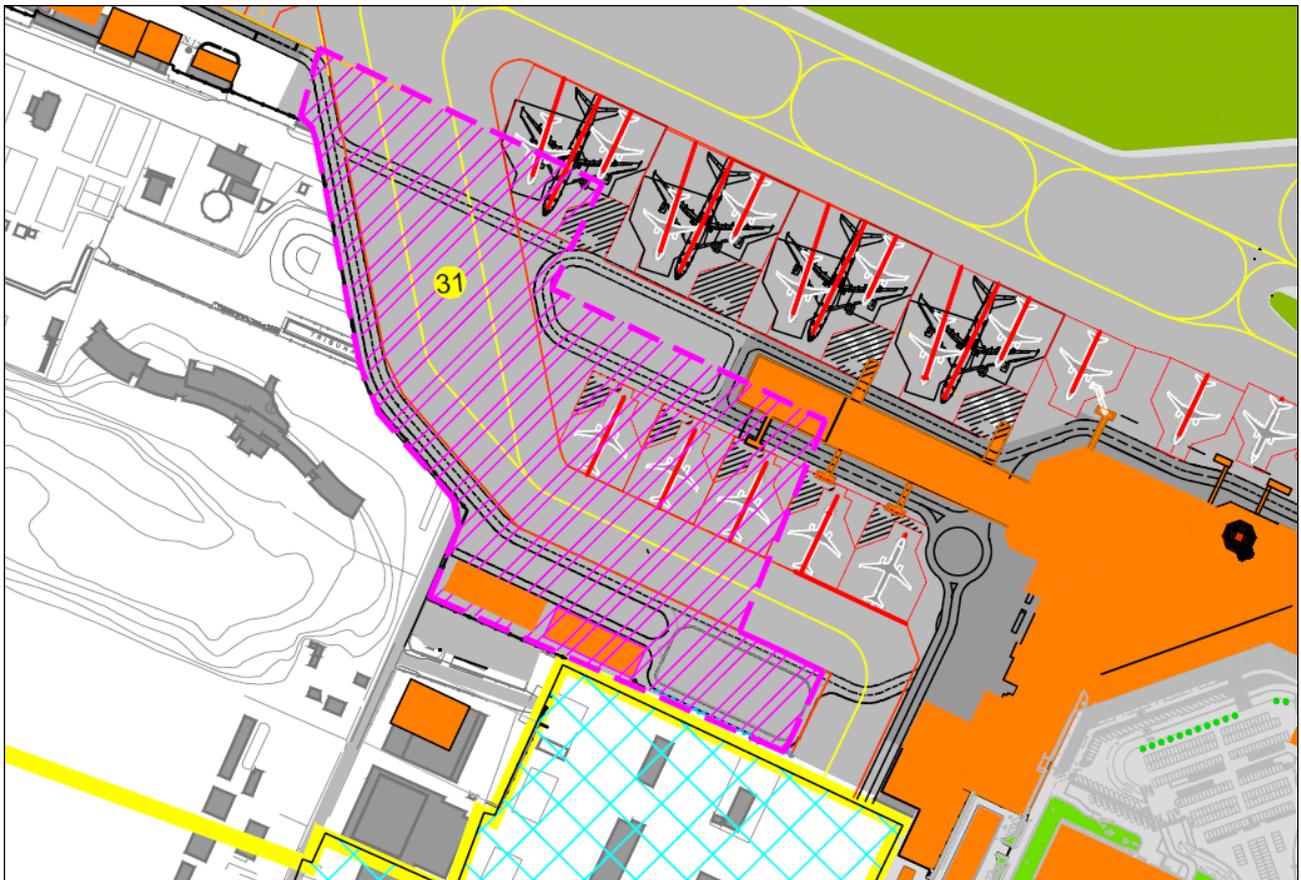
Estratto Master Plan – Ampliamento Apron 1
